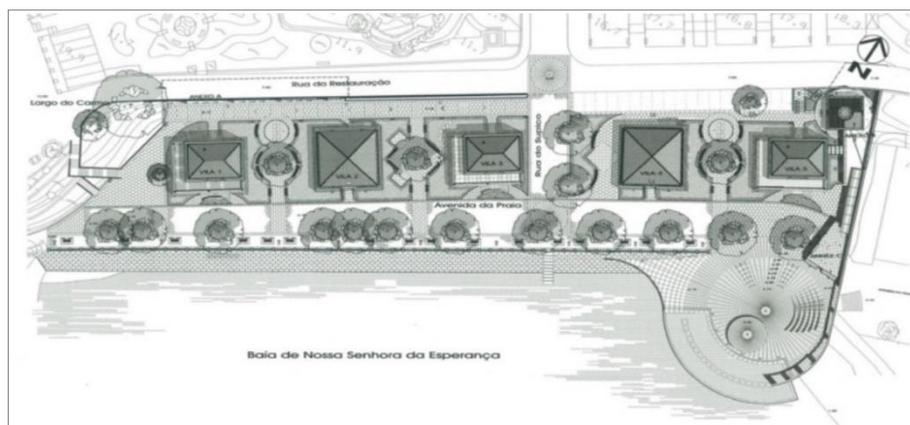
Planta do Conjunto Classificado Casas Museu da Taipa. Obra de renovação realizada em 1999.
